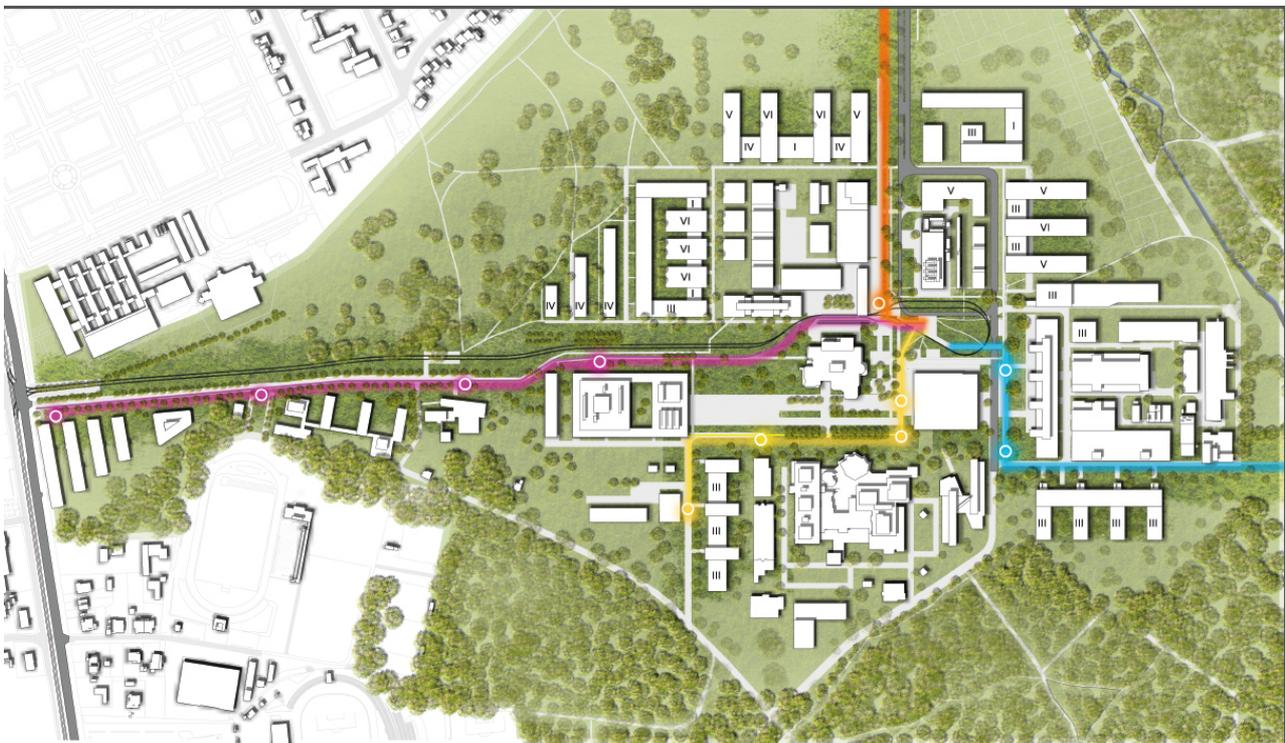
Lageplan Campus Lichtwiese TU Darmstadt, Orientierungspunkte / Hotspots
